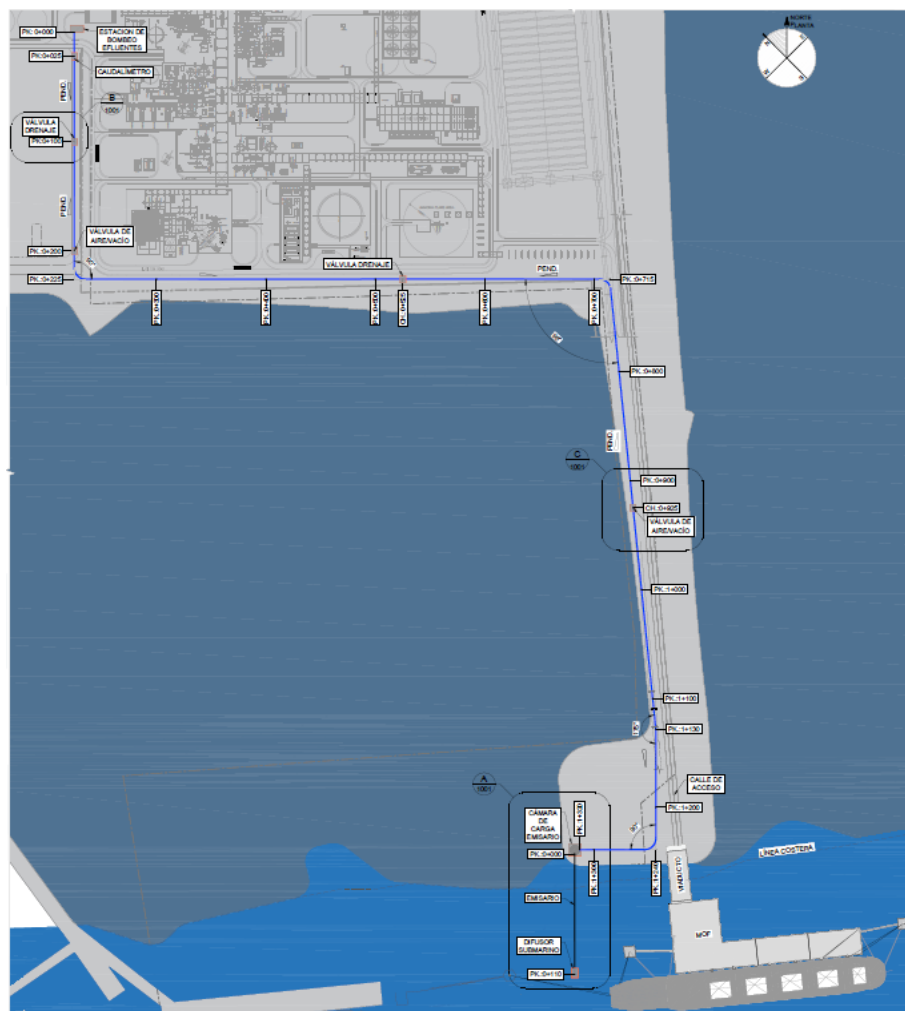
Layout sistema de descarga proyectado – Planta Fertil Pampa
